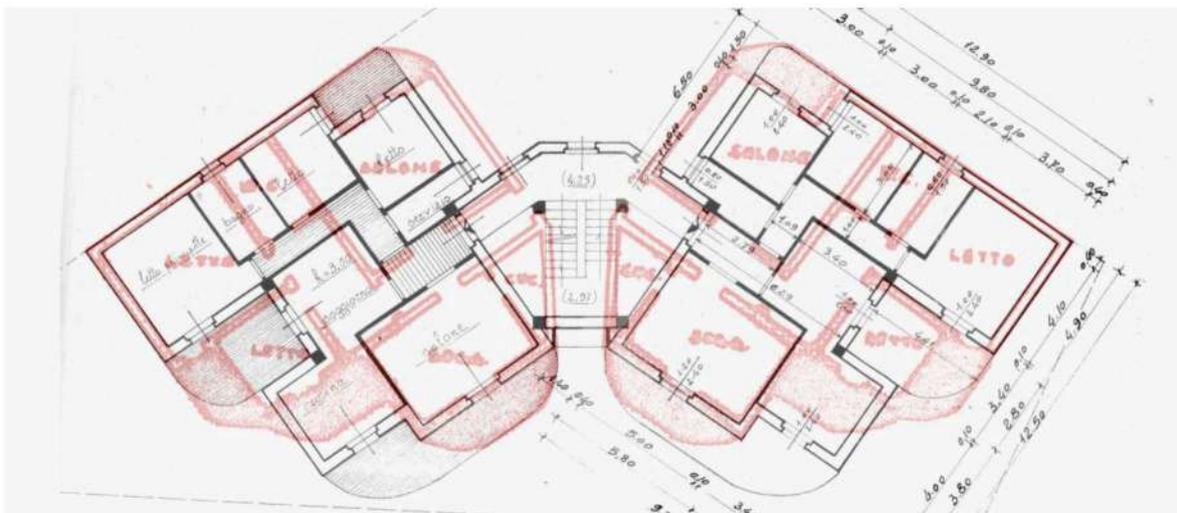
Sovrapposizione progetto di Concessione n.64/78 e planimetrie catastali - piano primo
